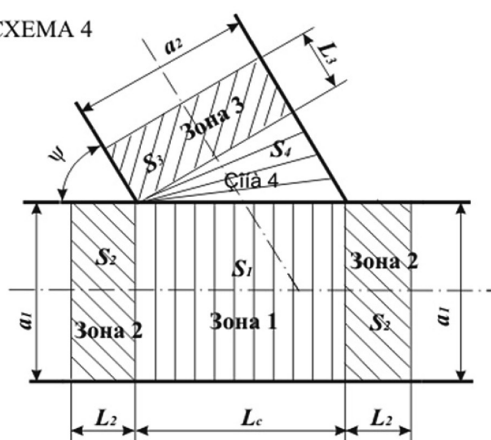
Расчетные схемы к определению площади обнажения кровли в различных зонах сопряжения выработок с односторонним ответвлением под прямым и острым углами
